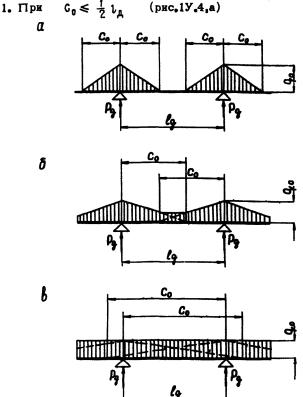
У.4. Схемы реактивного отпора кладки стены при
